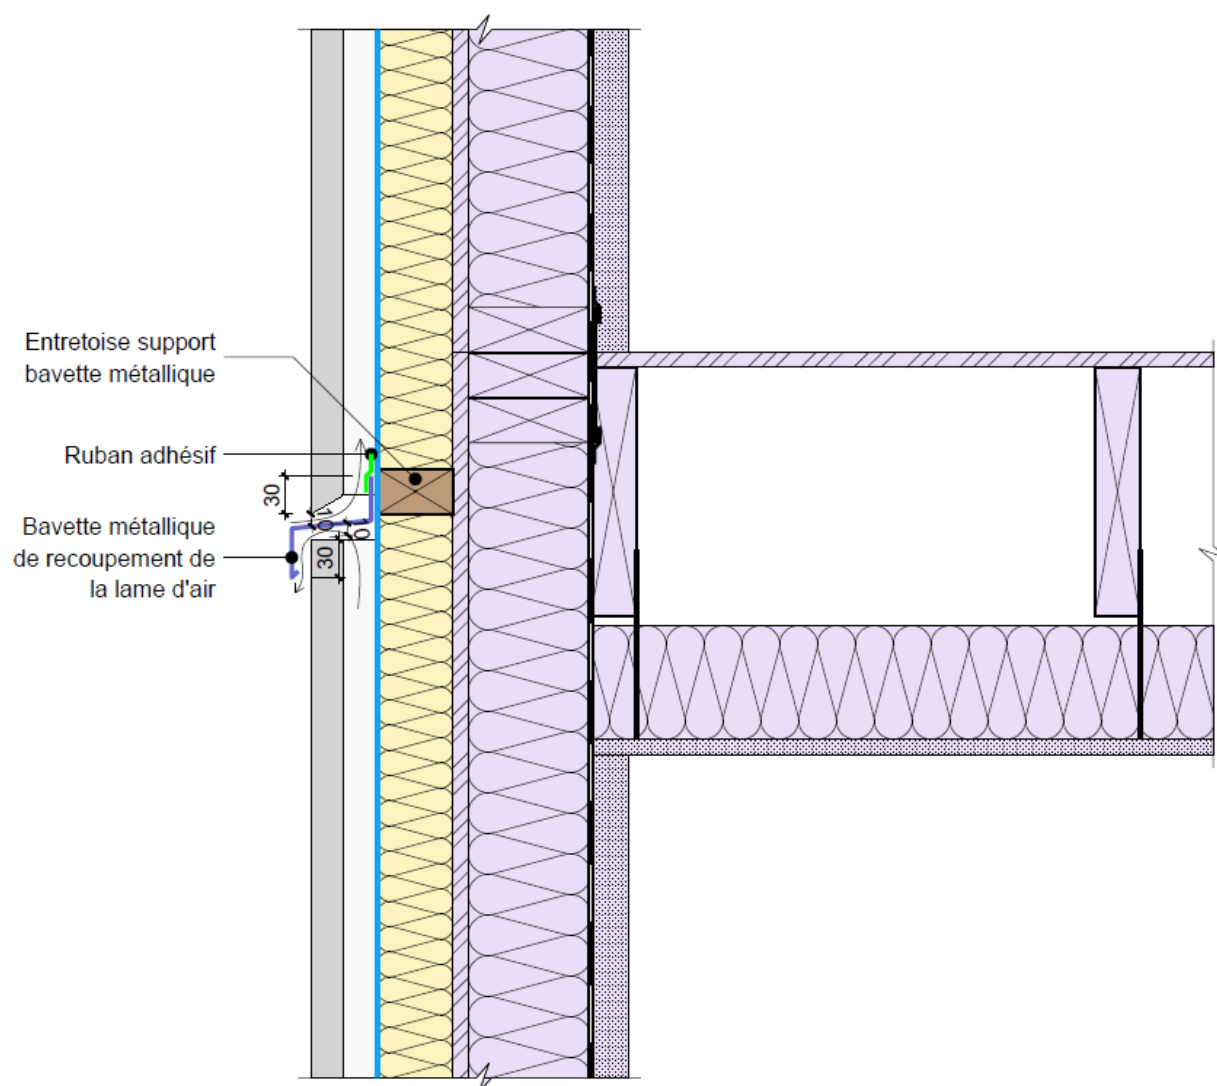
Plancher intermédiaire – avec fractionnement du bardage (coupe verticale)
